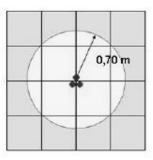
Planimetria individuazione fasce di rispetto determinate
